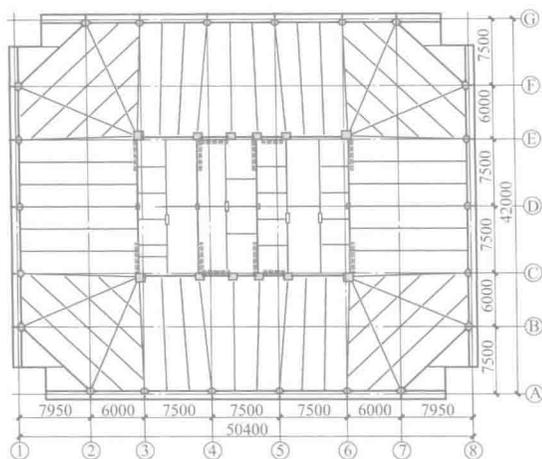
塔楼 34 ~ 顶层结构平面布置图
